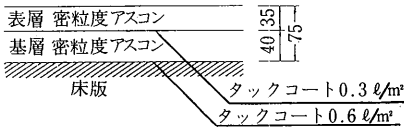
断面構造(標準舗装)(本線・ランプ) (単位: mm)
